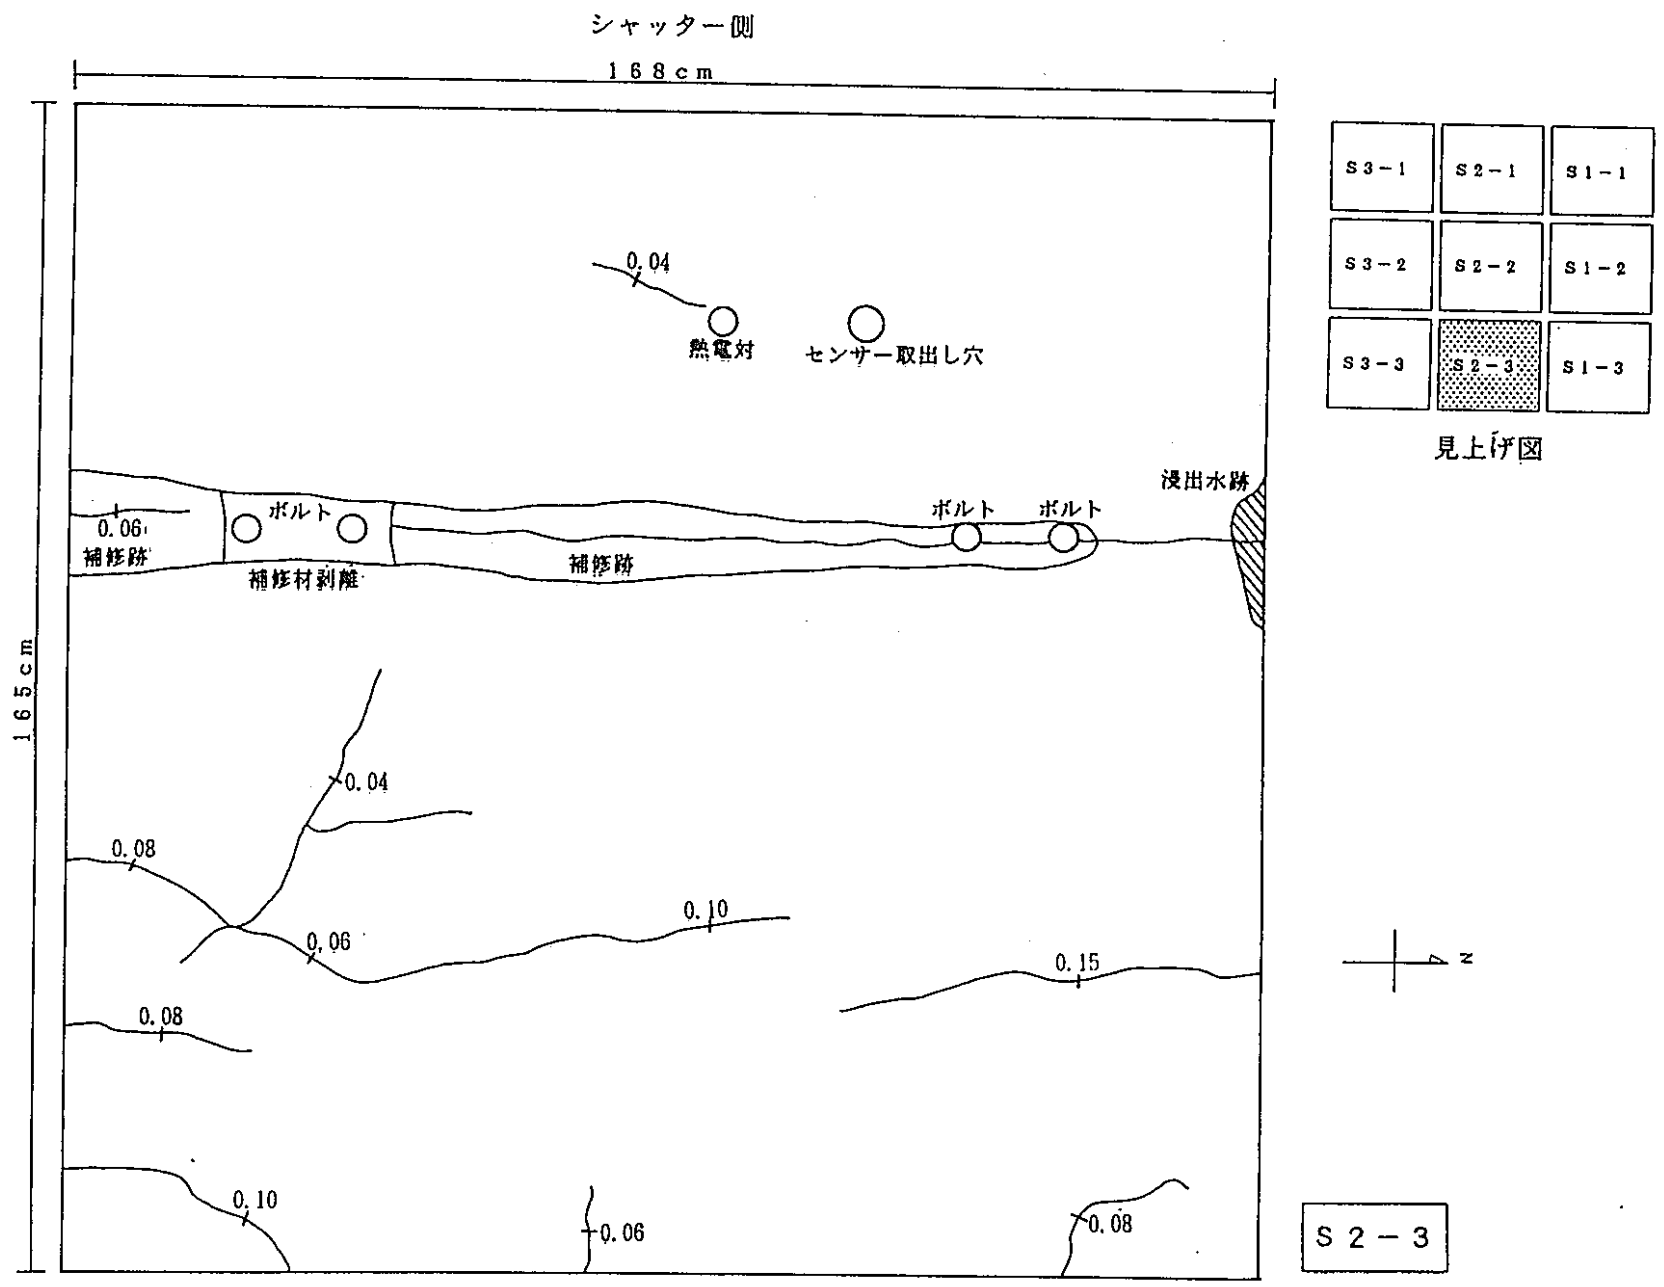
7 ひび割れ観察図 (S2-3)
